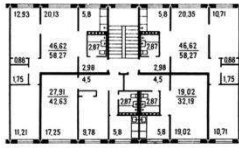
Прототипы секционного жилья (истоки формирования стереотипа многоквартирного жилья 60-80х годов в нашей стране)
